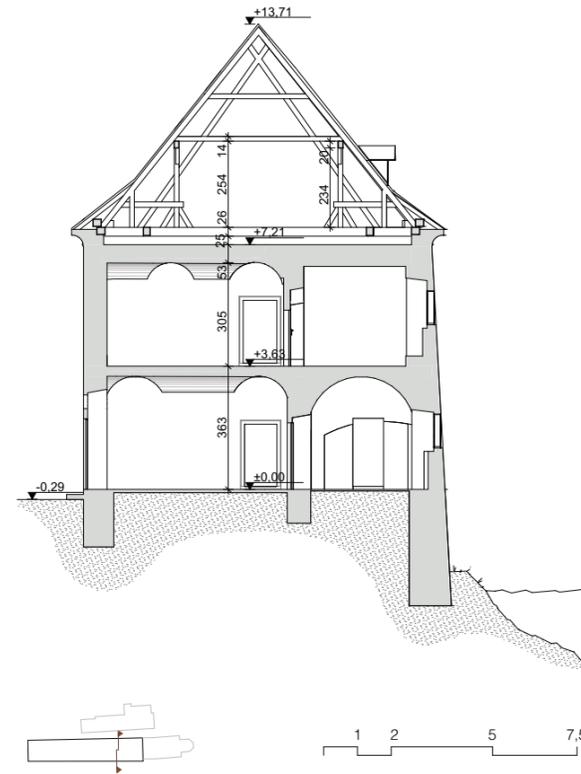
Bestandsplan. Schnitt A-A Spitalstrakt
